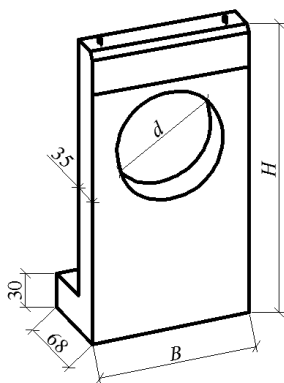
Блок порталной стенки для железобетонной круглой безнапорной раструбной трубы
